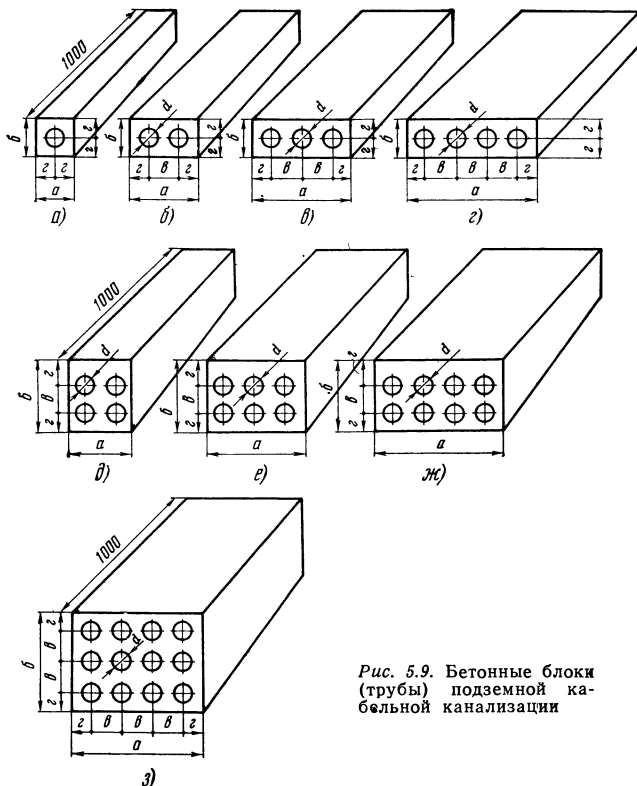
Бетонные блоки (трубы) подземной кабельной канализации
